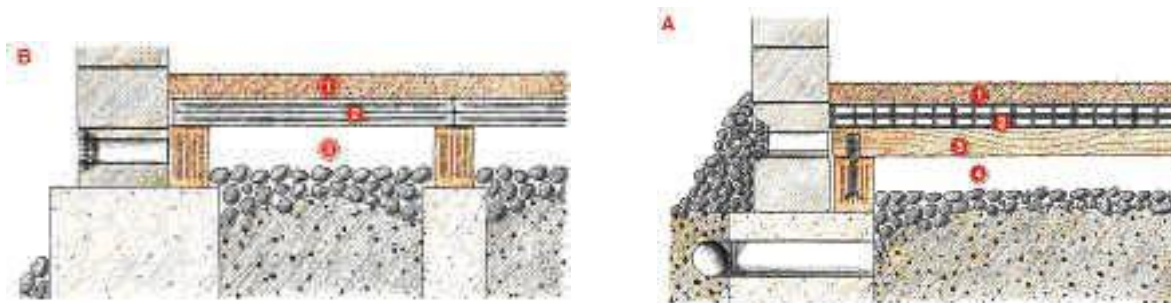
21 Schematizzazione di un solaio ventilato al piano terreno poggiante su travi di legno (A) e su tavelloni collocati su muretti di laterizio (B)
